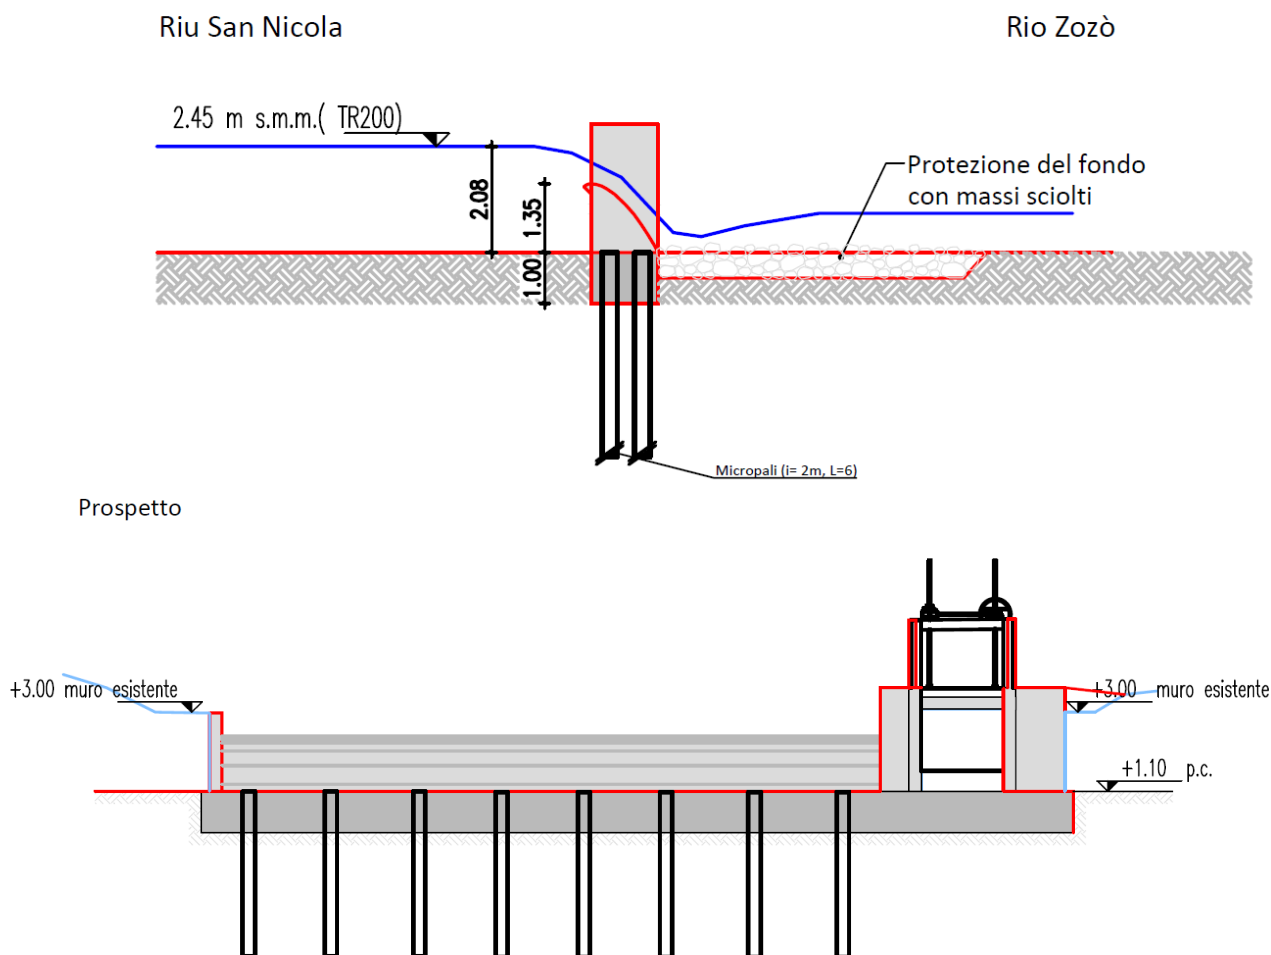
Sezione longitudinale e prospetto dell'opera di regolazione sul diversivo San Nicola – Zozò.
